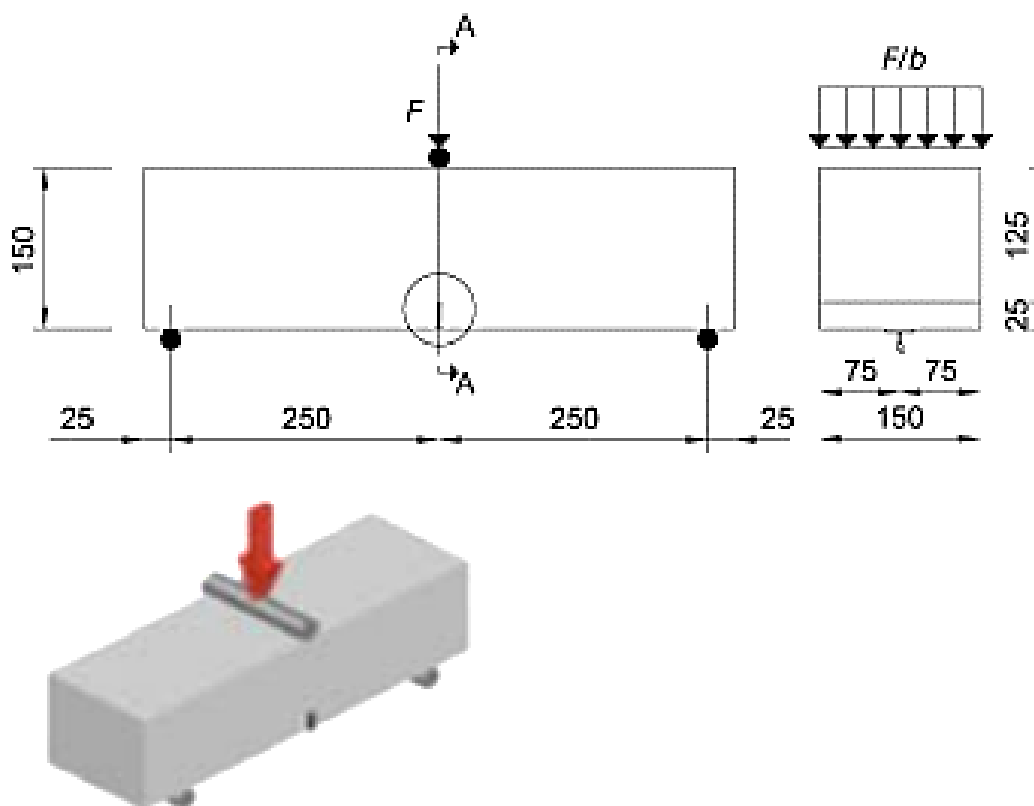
Detalle del ensayo "Three point bending test"
